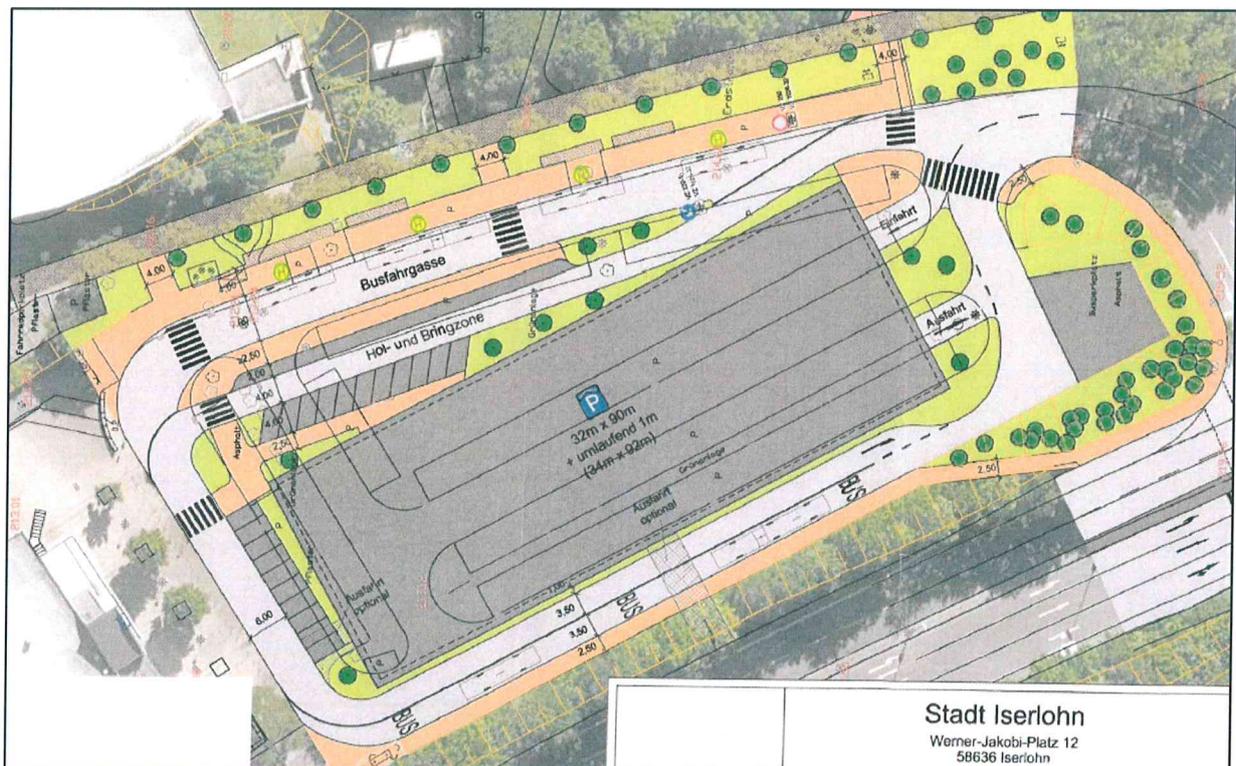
Lageplan mit Eintragung der geplanten Bebauungsfläche an der Seilerseestraße in Iserlohn
